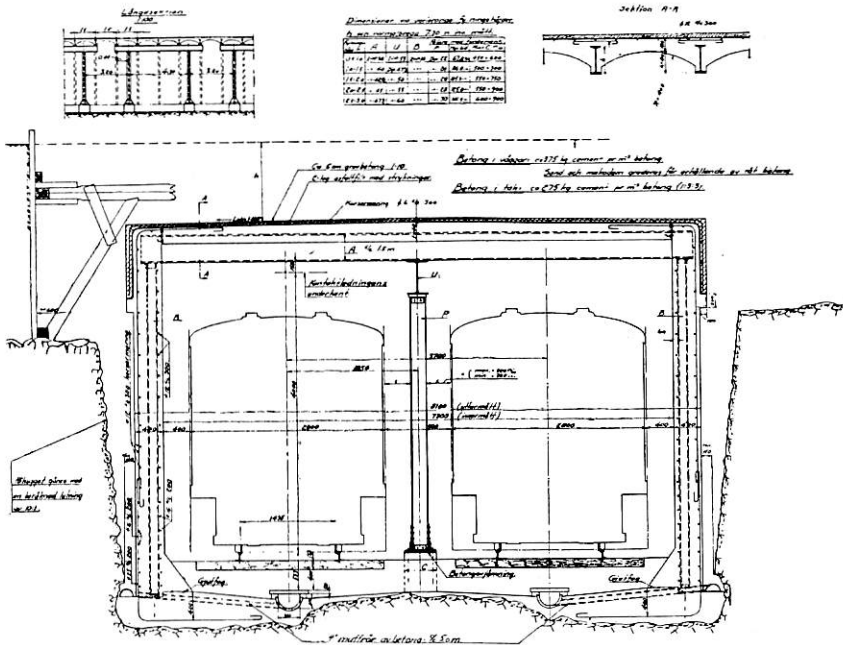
Normalsektion av betongtunneln med järnkonstruktion.
